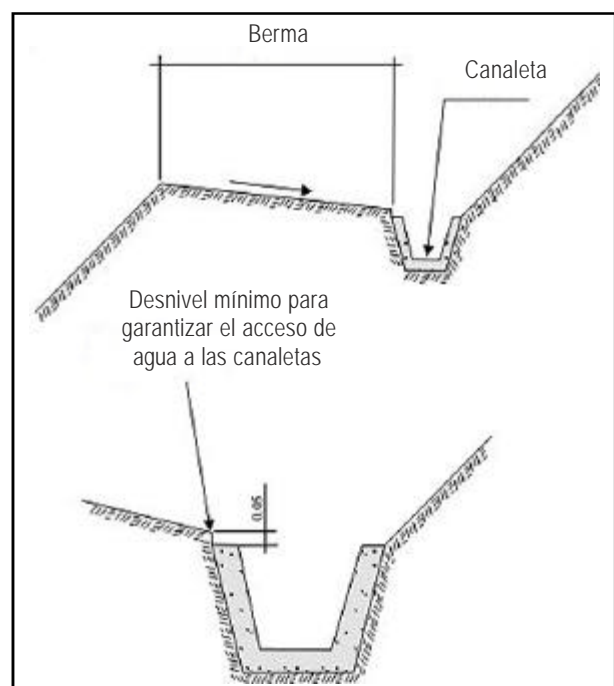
Detalles de una canaleta de drenaje superficial.
